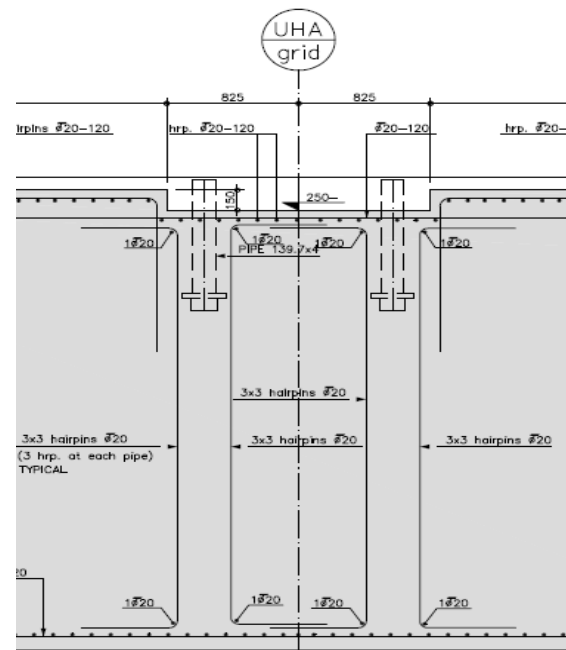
Planausschnitt Rückhängebewehrung zur Weiterleitung der Lasten and den Fundamentgrund.
